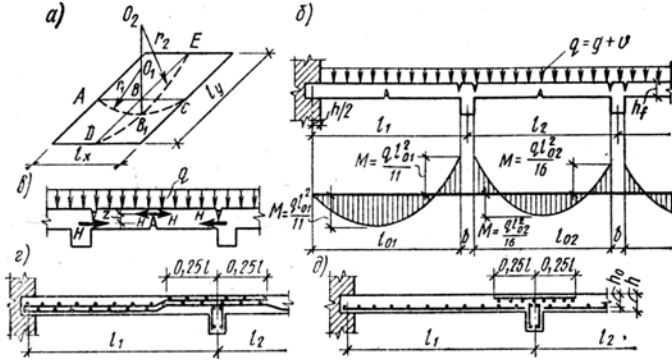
Расчетная схема и армирование монолитных балочных плит
